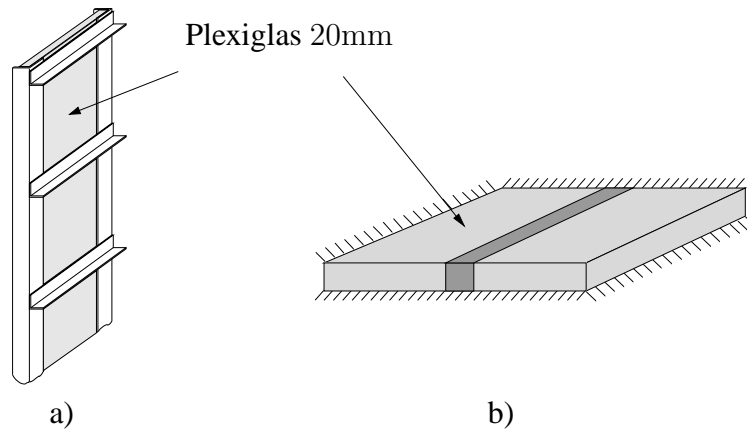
a) Wandaufbau: Plexiglas mit Stahlprofilrahmen b) Reduktion: Eingespannte Platte approximiert durch eingespannten Balken
